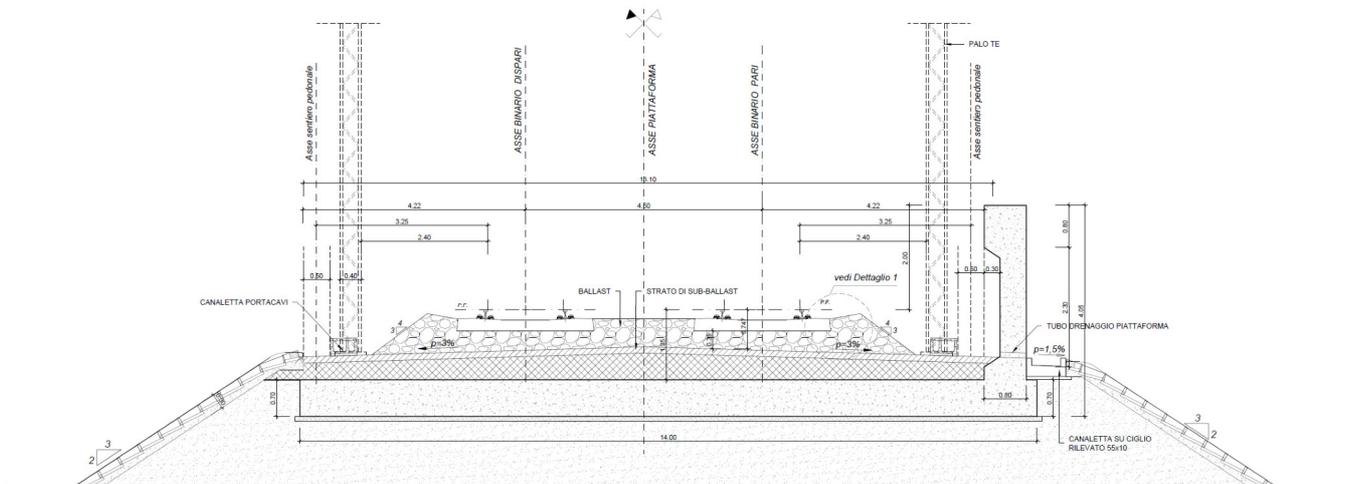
Sezione tipo in rilevato a doppio binario con muro di recinzione (tipo R01)
